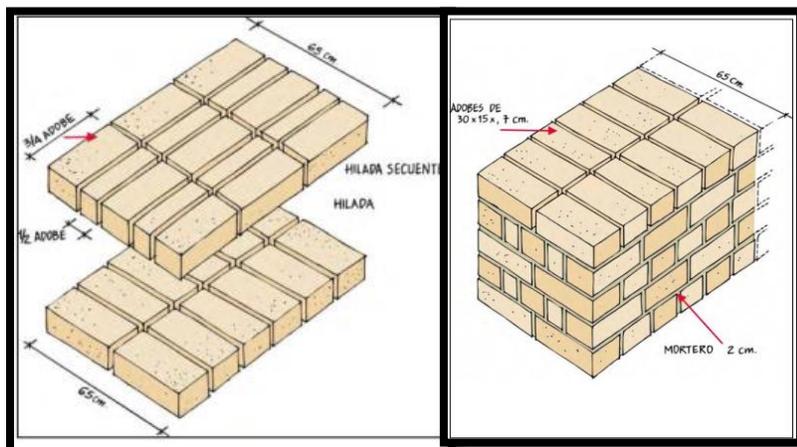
Una hilada compuesta de dos adobes en tizón y la siguiente de tres
